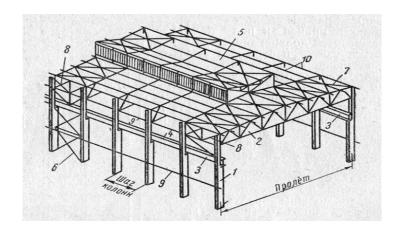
Основные элементы стального каркаса промышленного здания. 1 - колонна рамы;
